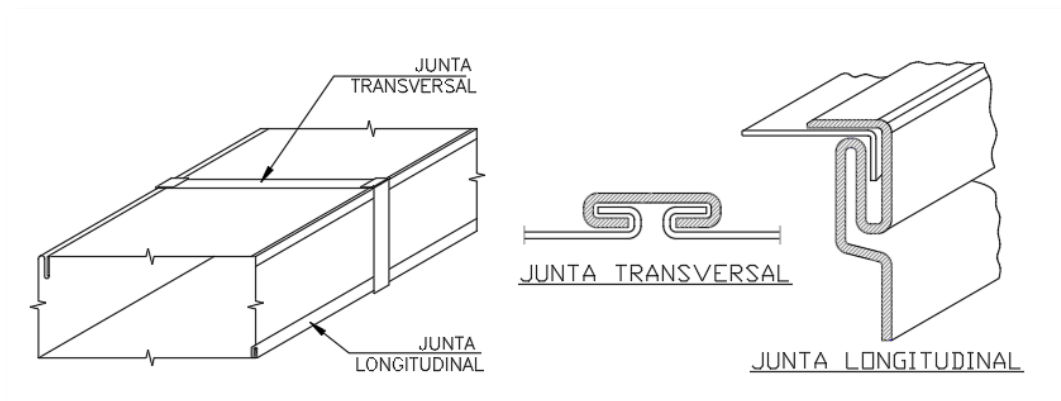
Detalle de ensamblaje de ducto de F⁰G⁰. Elaborado en AutoCAD en base a los criterios de fabricación.
